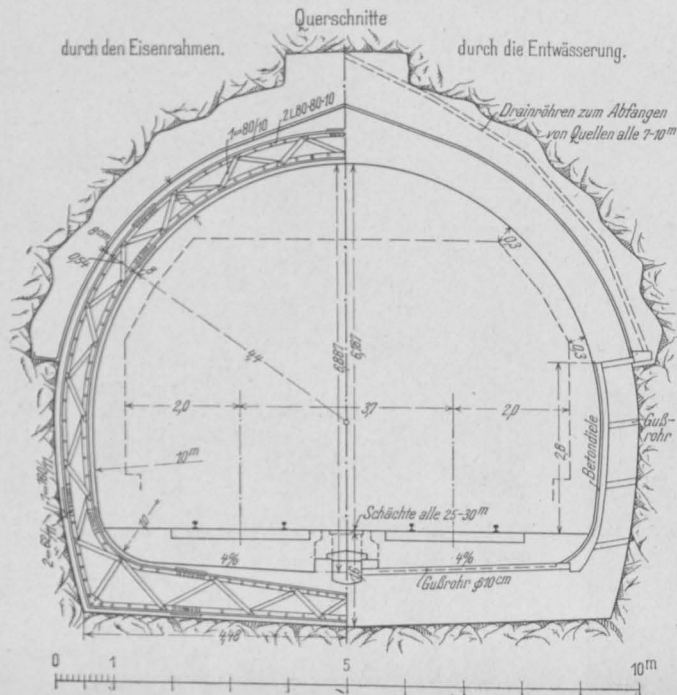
Eisenbeton-Ausmauerung des Pragtunnels bei Stuttgart.
